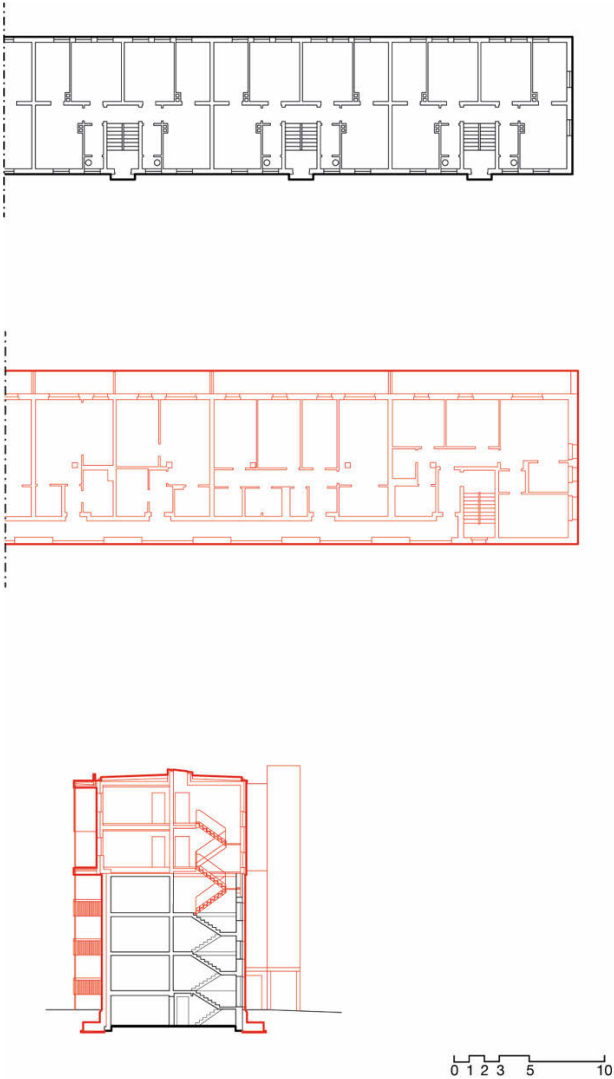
Grundrisse & Schnitte Bestand – Aufstockung 2, Attenkoferstraße
